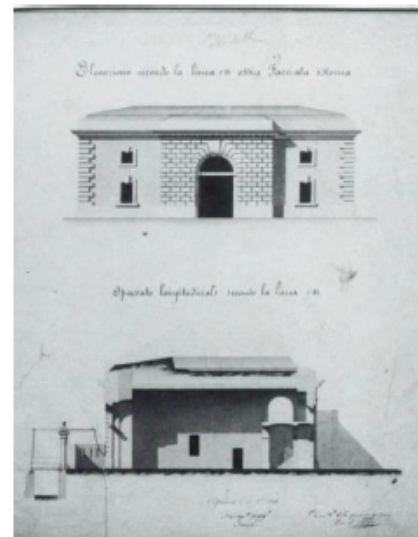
Facciata interna e sezione longitudinale della porta Reale. Ing. Danesi, 12 ottobre 1826.
